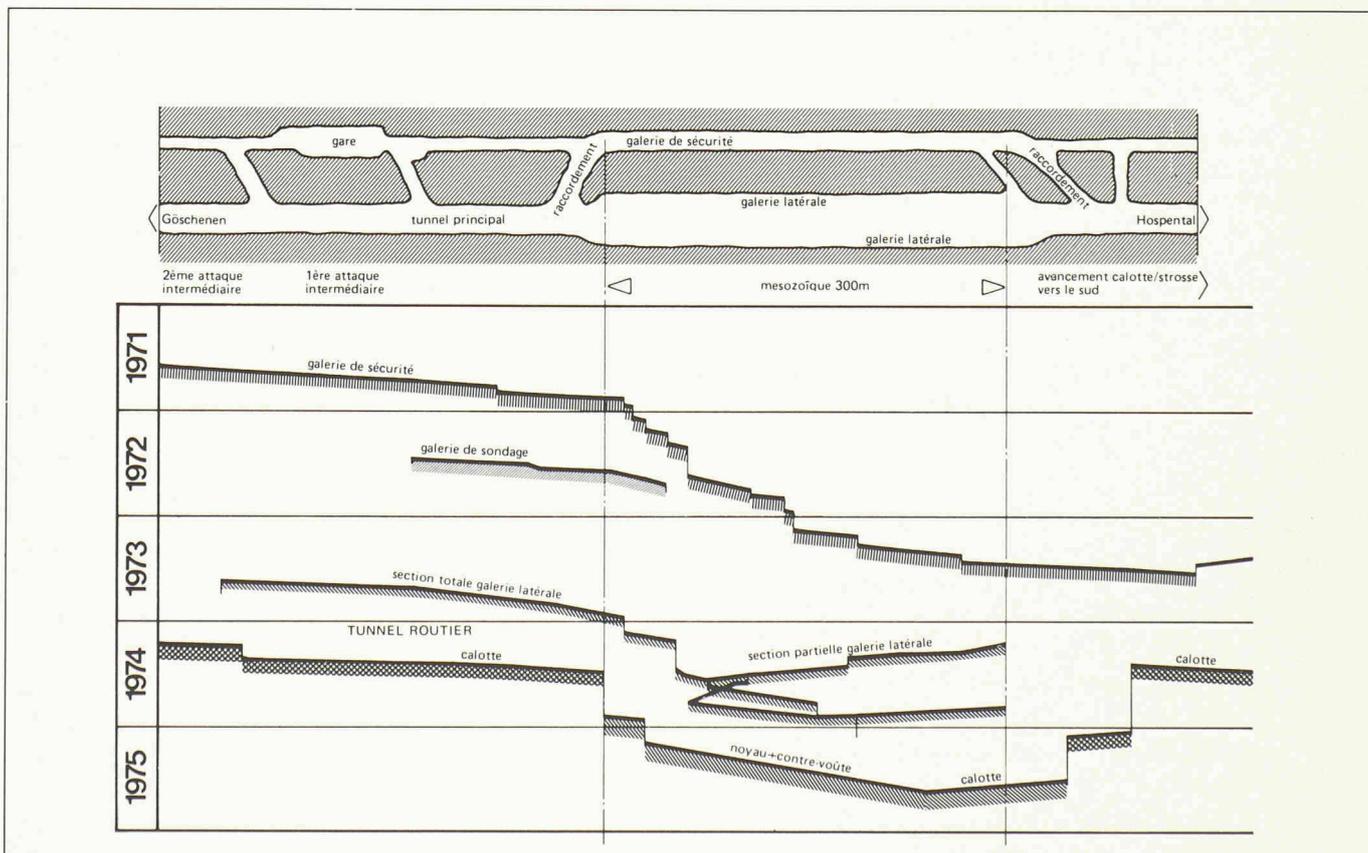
Développement des travaux dans la zone du mésozoïque du tunnel routier du Saint-Gothard.
